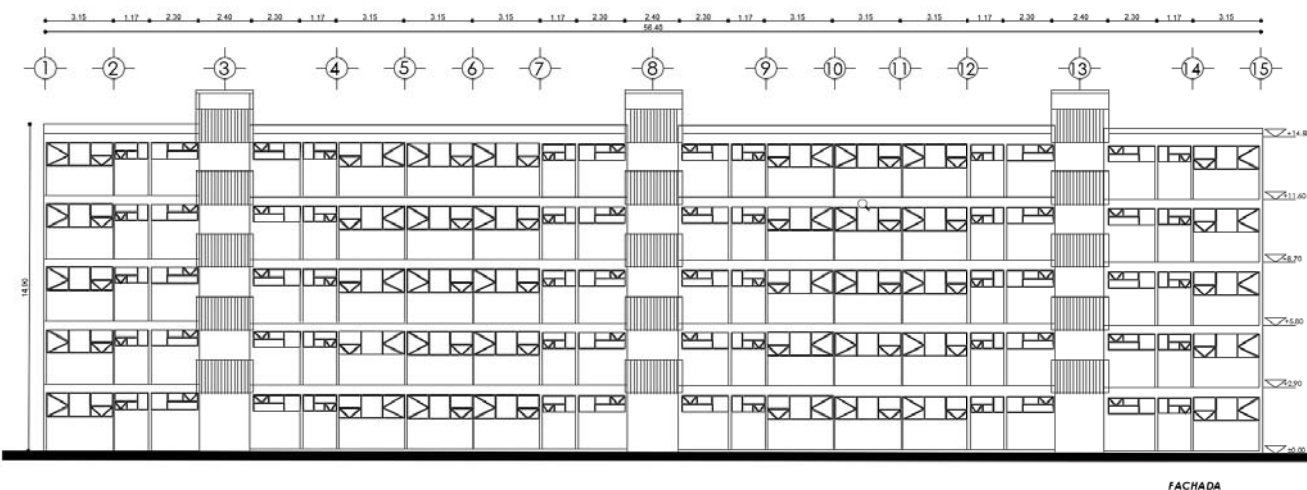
Fachada tipo del edificio 4A, 4B Y 4C
